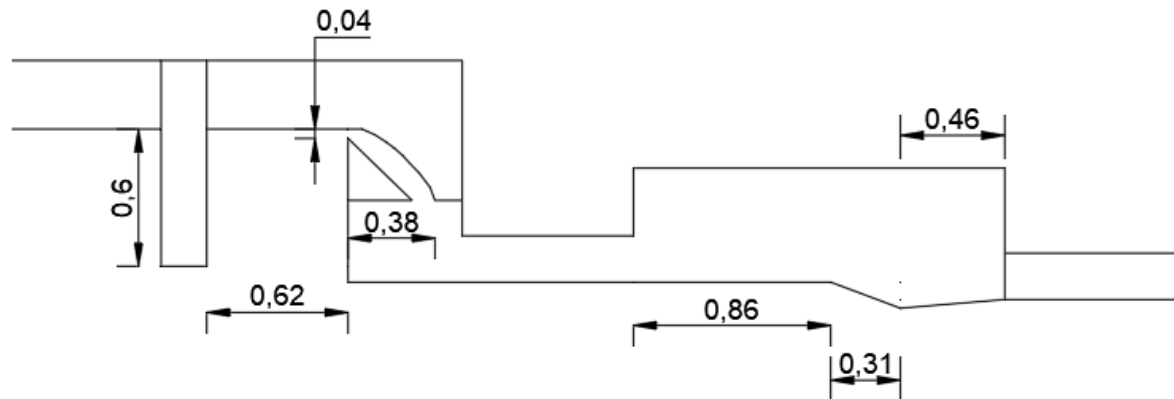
Detalle Vertedero de salida y Canaleta (corte), tomada de software AutoCAD.
